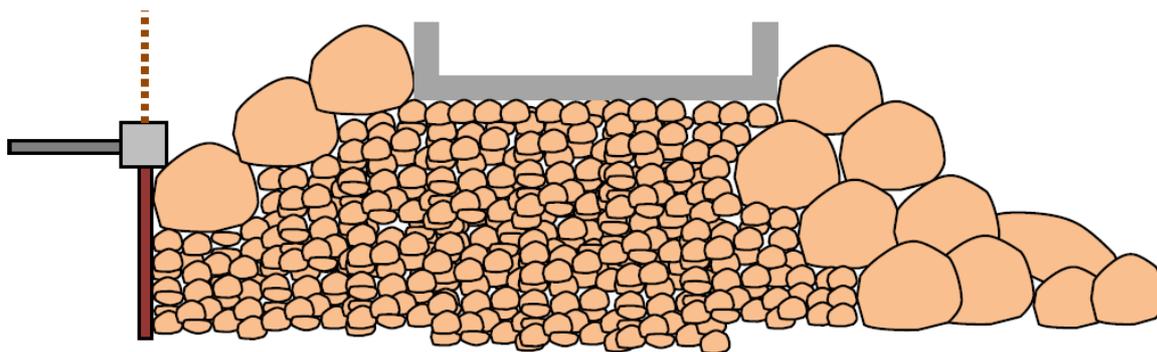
schéma de principe coupe transversale de l'ouvrage
